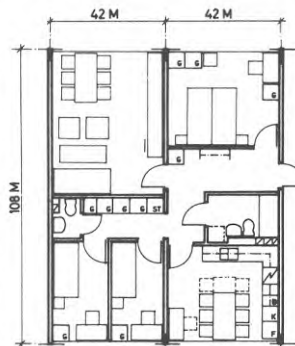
Planlösning med lägenhetsytan 87 m<sup>2</sup>
